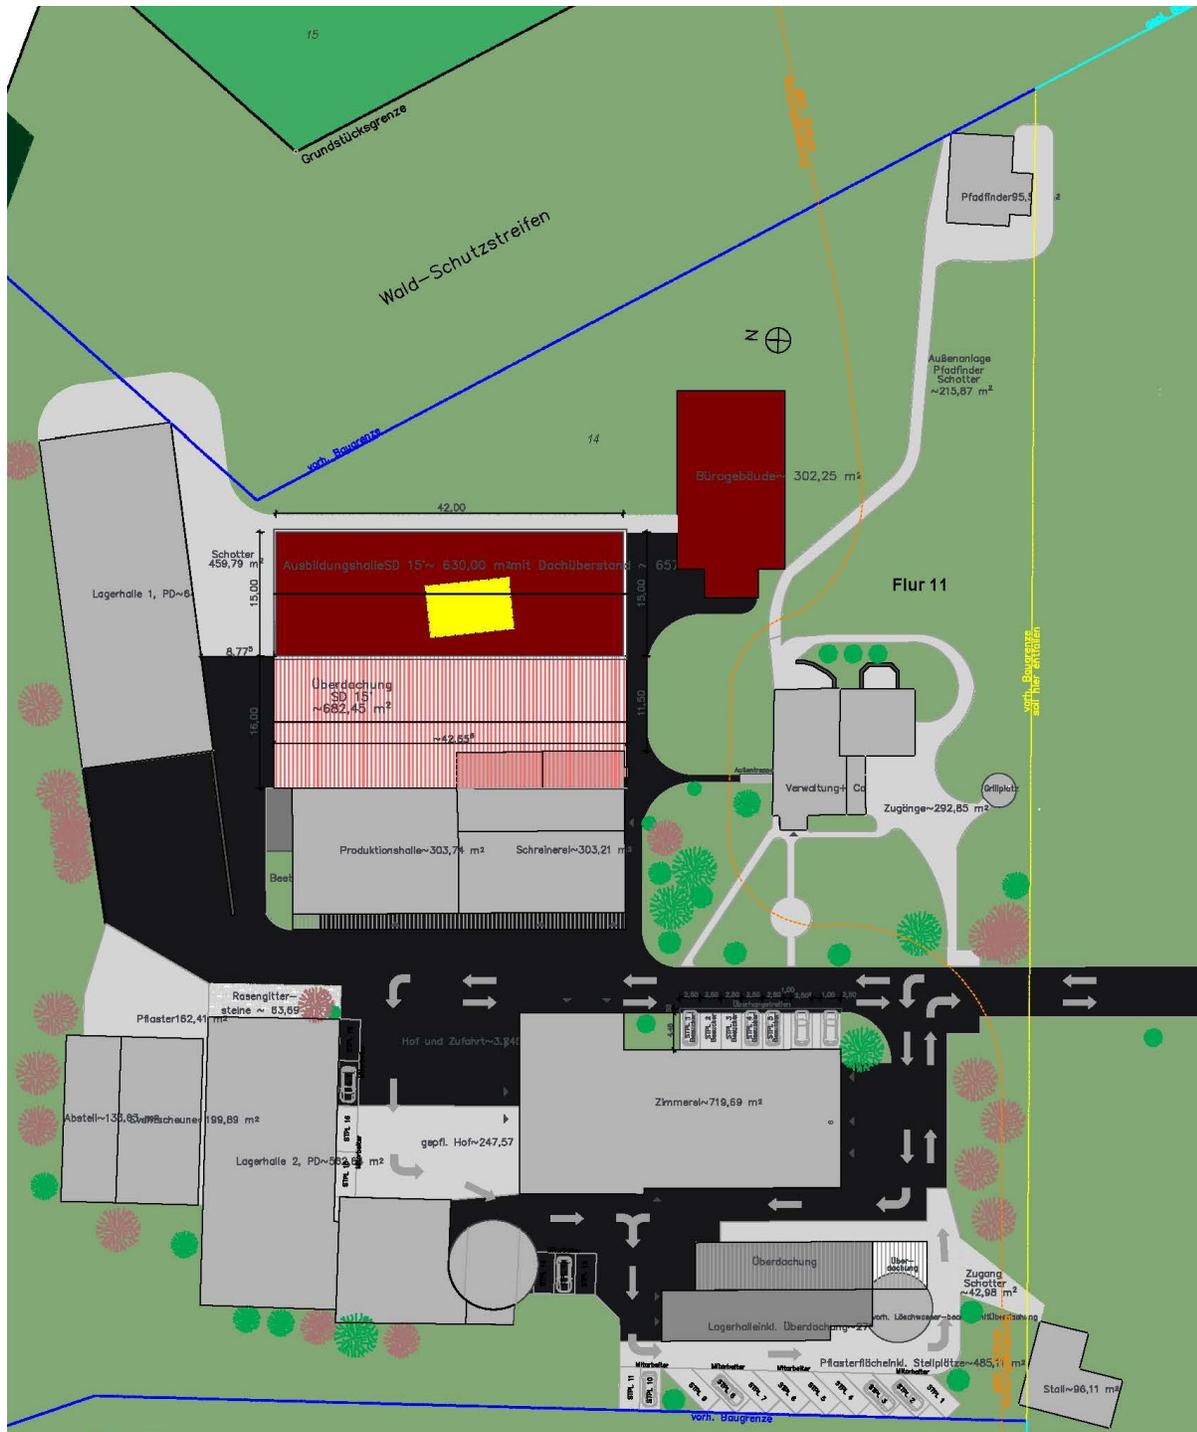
Geplante Erweiterungen, flächig rot bzw. rot schraffiert dargestellt, im Bereich Sondergebiet Gefährdetenhilfe (Ausbildungshalle, Bürogebäude und Überdachung), Auszug aus Fachplanung KDREI Ingenieure und Architekten, Dillenburg, Stand September 2022
